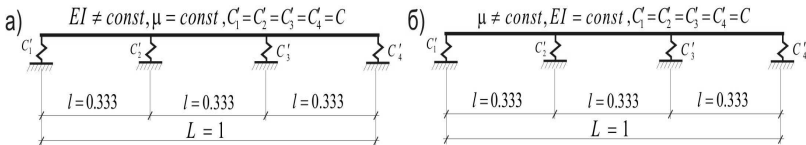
Расчетная схема трехпролетной балки на упругих опорах:
